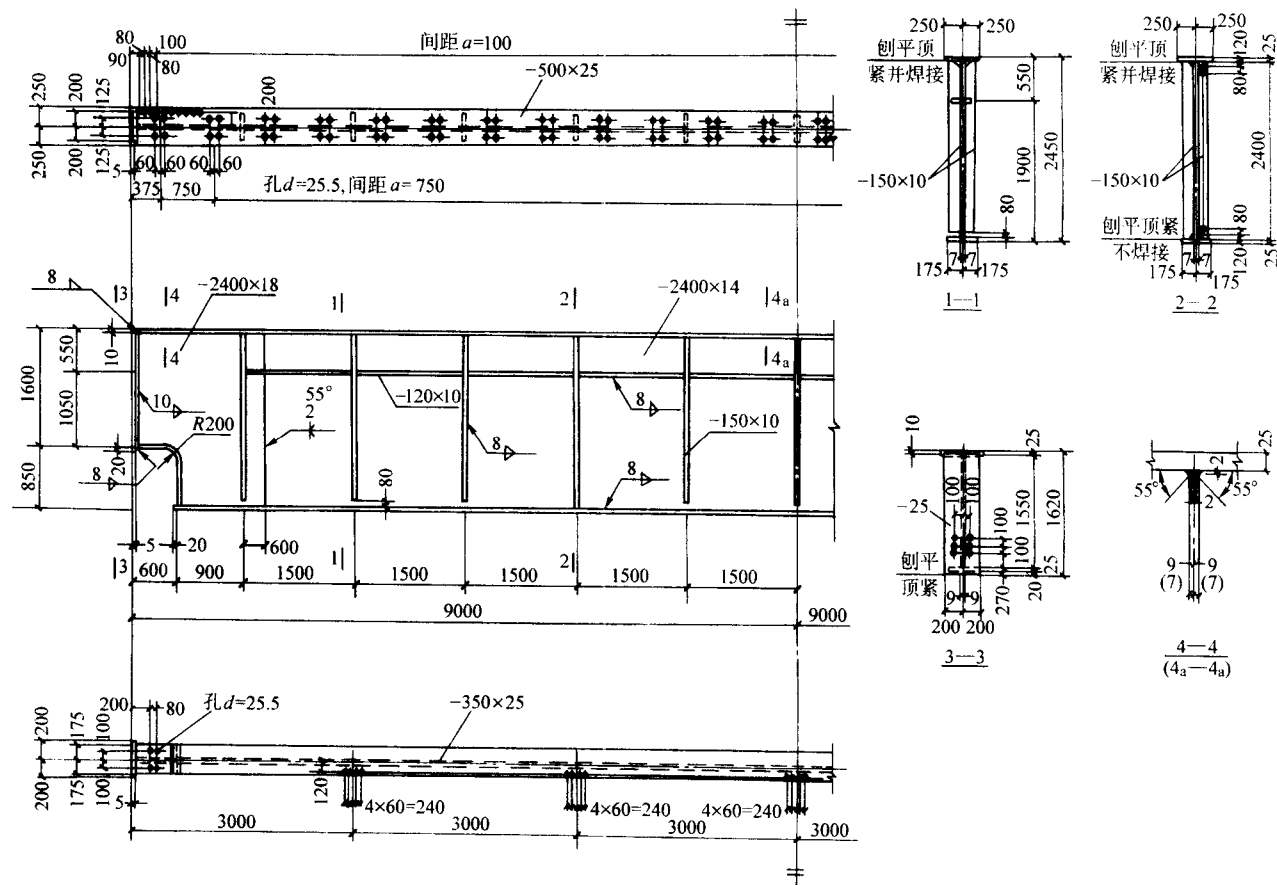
18 m 焊接工字形吊车梁结构
